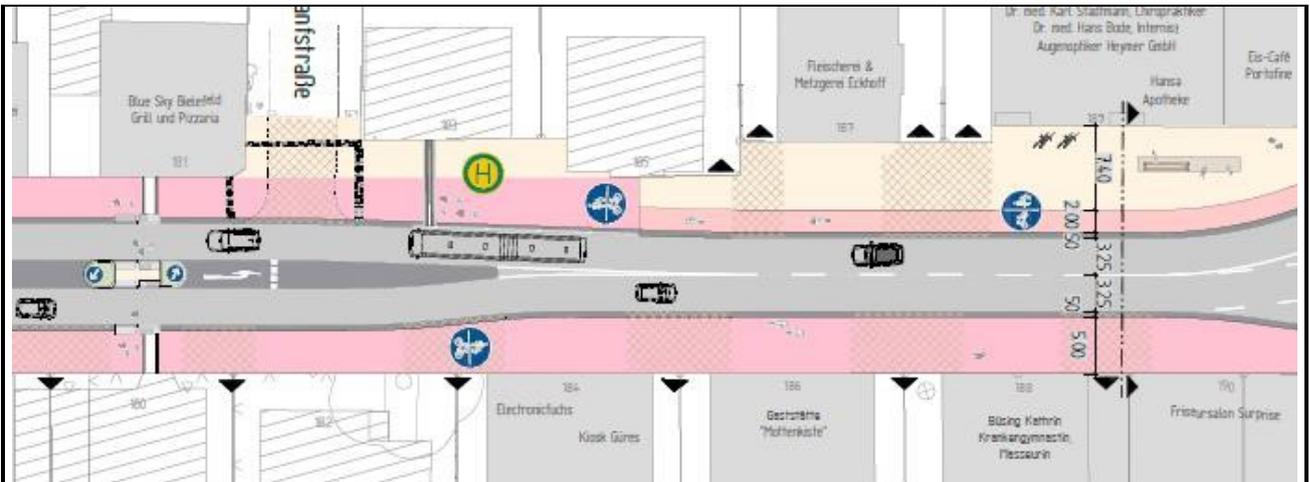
Lageplan zwischen Hanfstraße und Otto-Brenner-Straße
